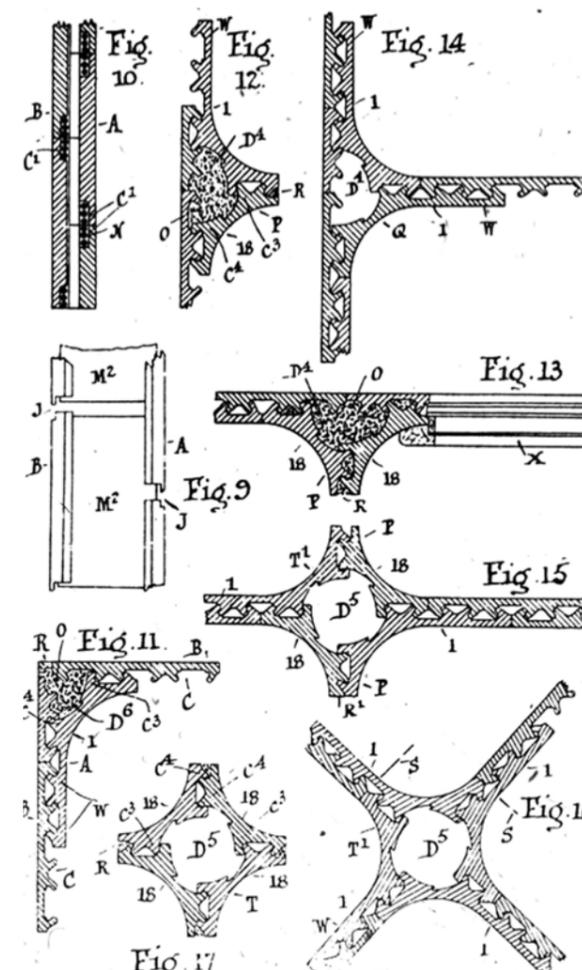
Detalle de las diferentes piezas del sistema Knitlock. Fuente: Turnbull, Jeffrey John. "The Architecture of Walter Burley Griffin: Concrete Applications". *Second International Congress on Construction History*, 3 (2006): 3133-3151.
